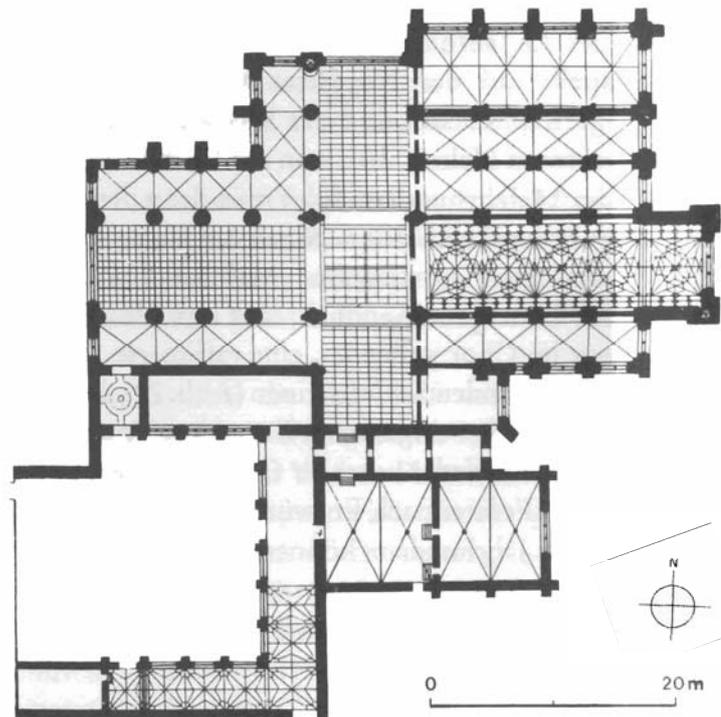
34: Christ Church Kathedrale: Grundriss
